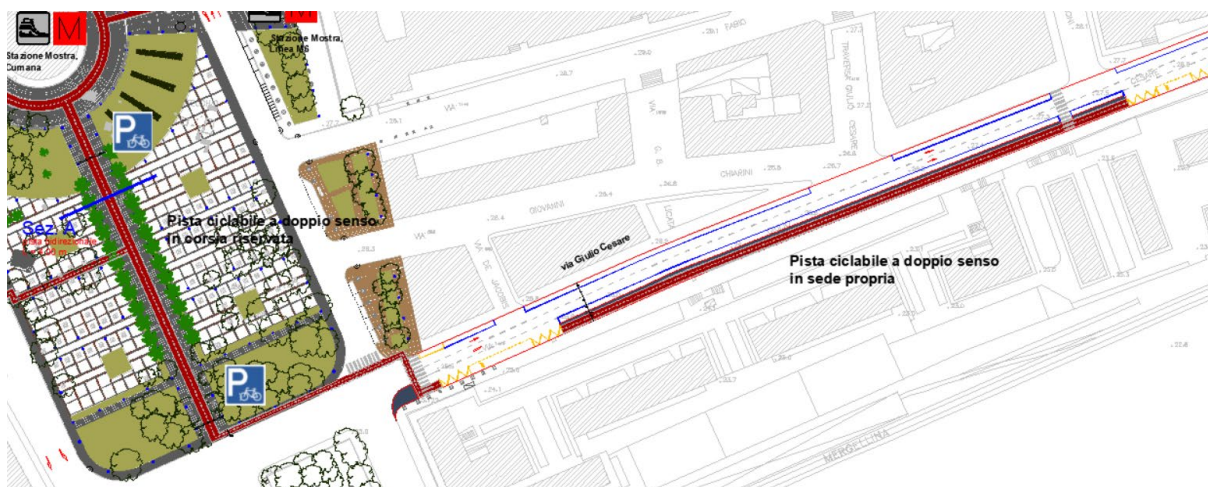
via Giulio Cesare, tratto iniziale – andamento planimetrico.
